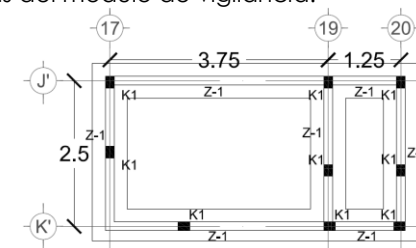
Planta de cimentación con zapatas corridas del módulo de vigilancia.
